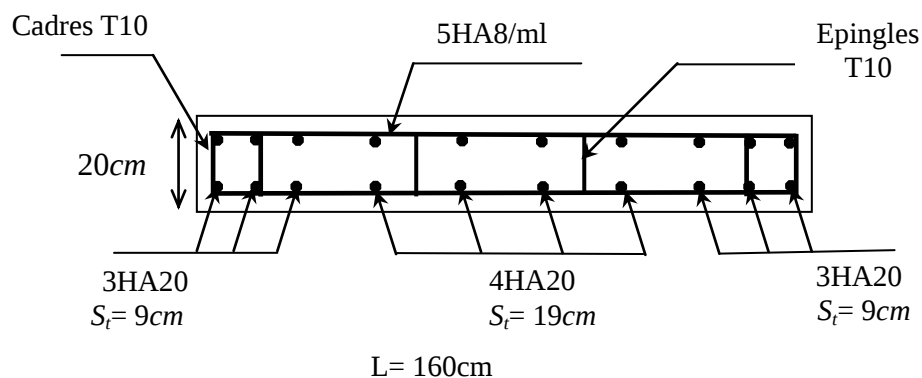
Schéma de ferrailage du voile Vx4 au niveau du RDC
